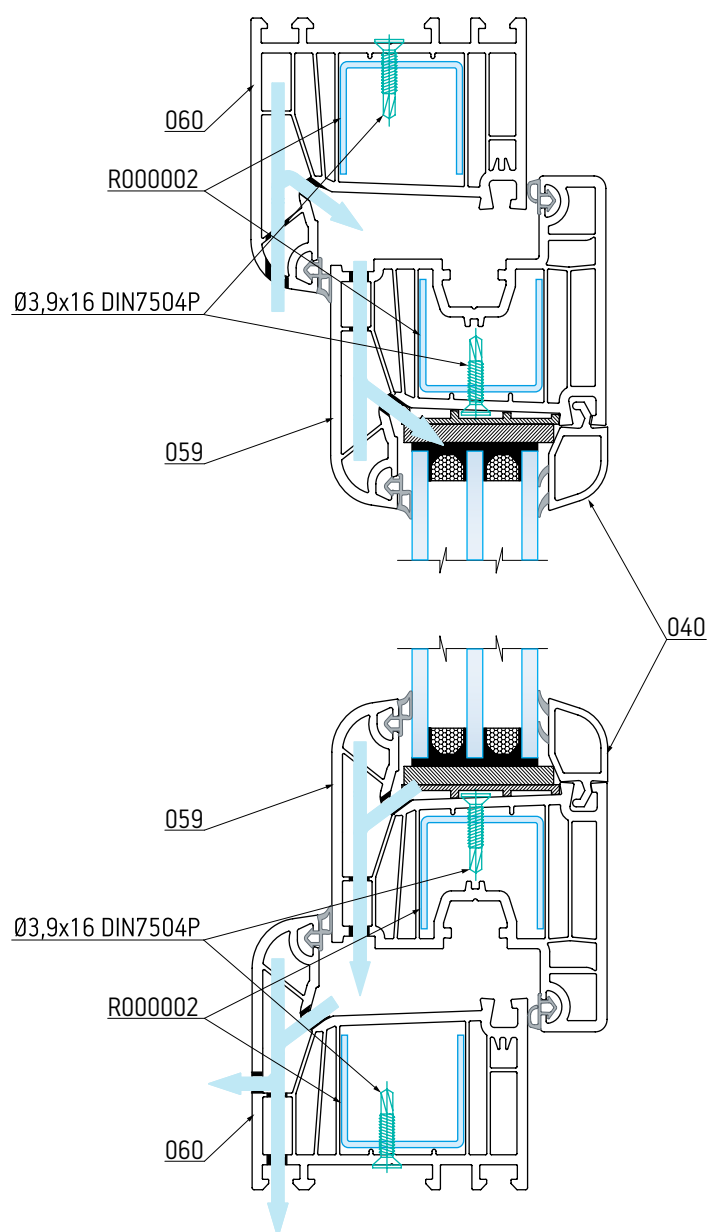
Типовые схемы вентиляции предкамеры для цветных профилей
